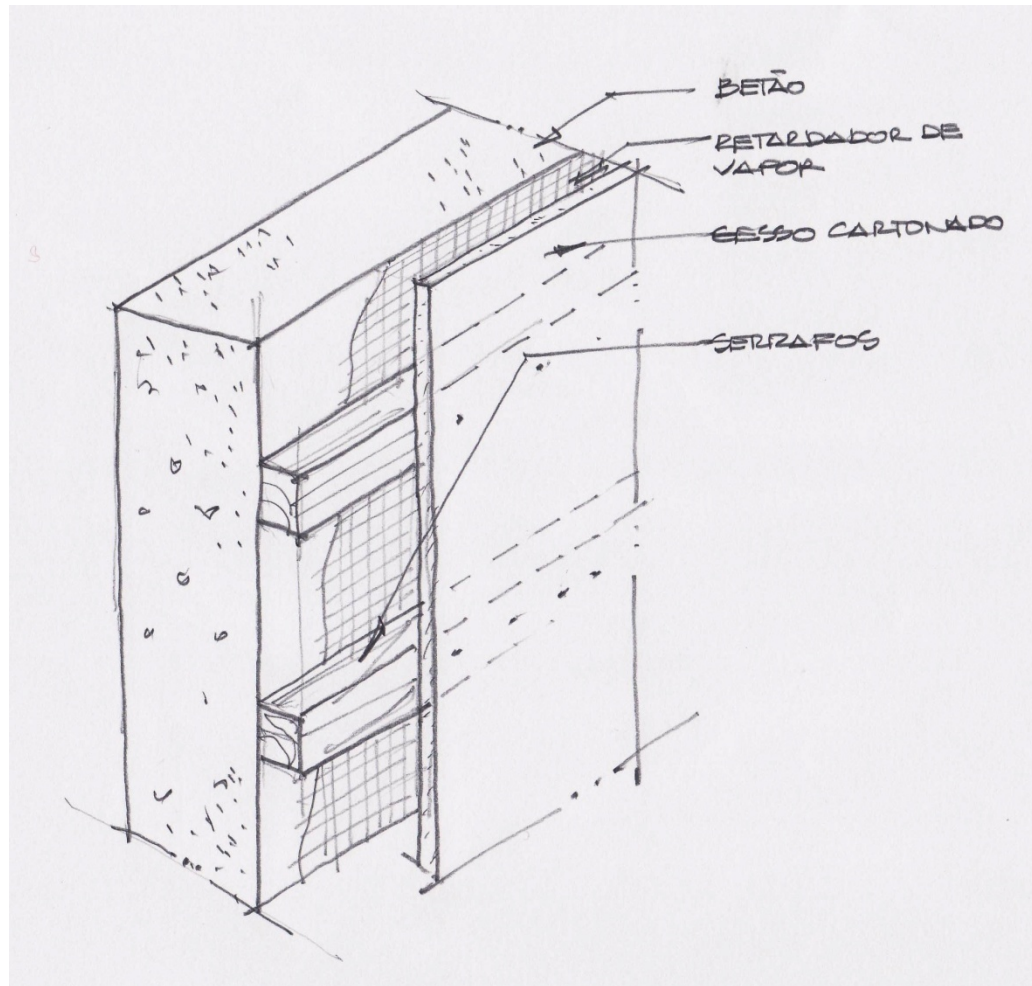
Protecção contra a deterioração da construção no contacto com elementos de betão. (des. autor)
